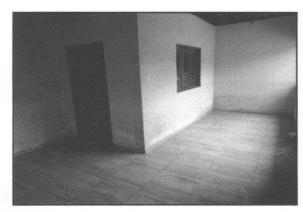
Vista da Varanda, com destaque para o revestimento cerâmico
